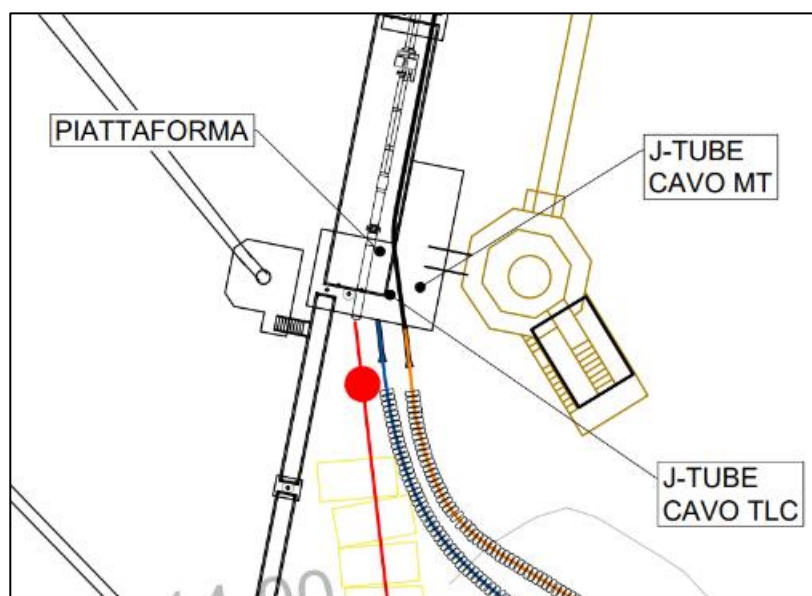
Particolare della risalita delle infrastrutture di collegamento (condotta gas, cavo TLC e cavo MT) sulla piattaforma di ormeggio offshore
